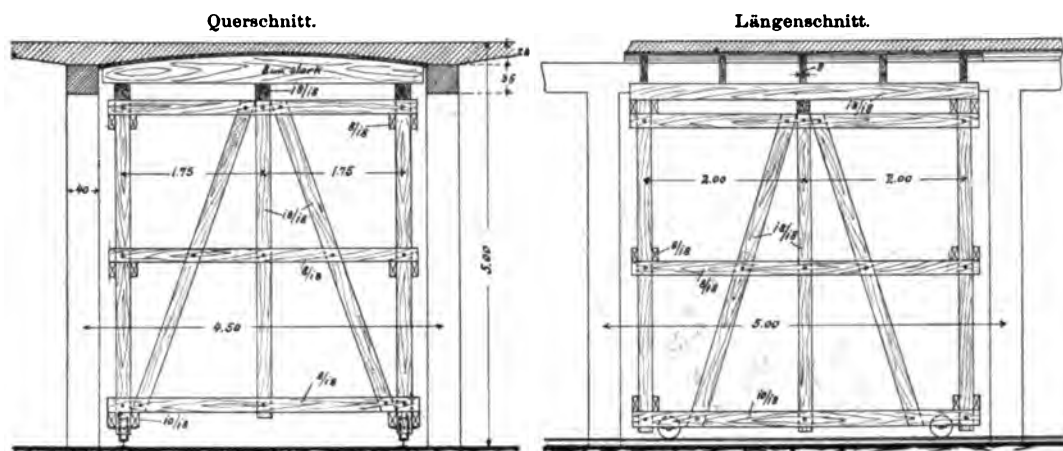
Fahrbares Schalgerüst zur Herstellung der Deckenplatte.
